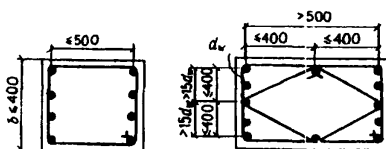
Конструкция пространственных арматурных каркасов в сжатых элементах
